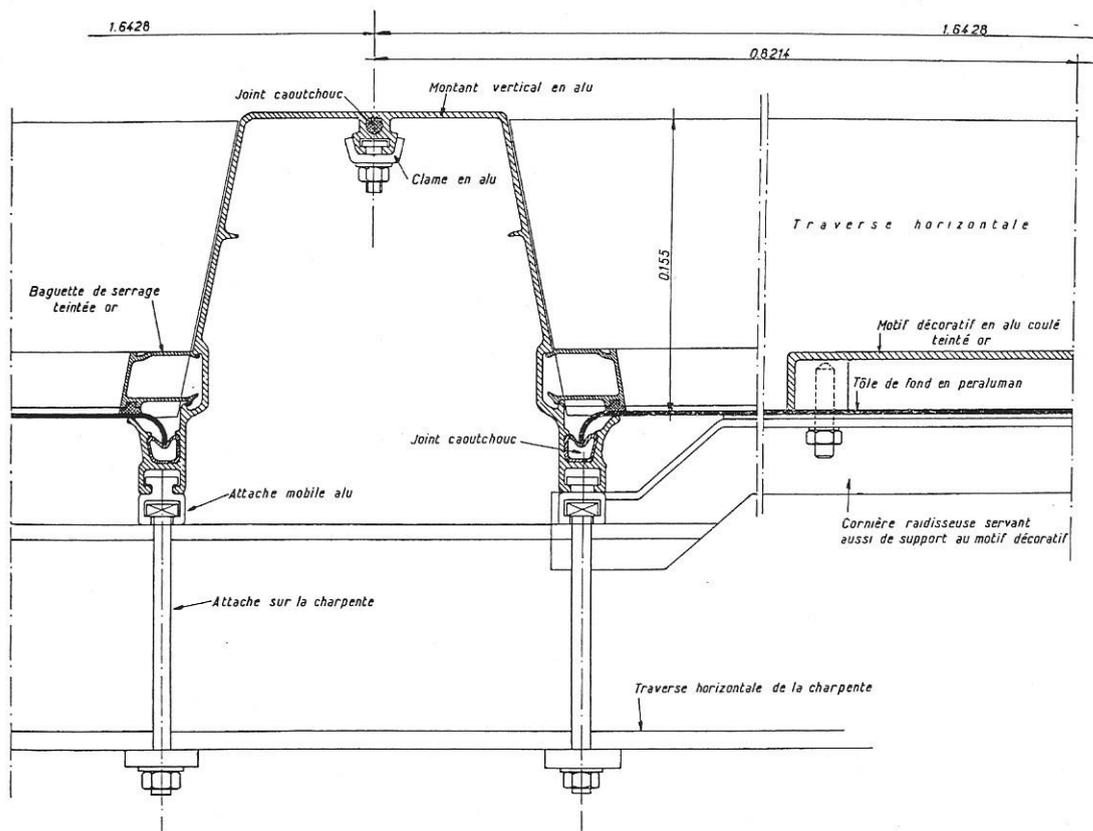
COUPE VERTICALE LONGITUDINALE COURANTE (voir plan, fig. 3).
